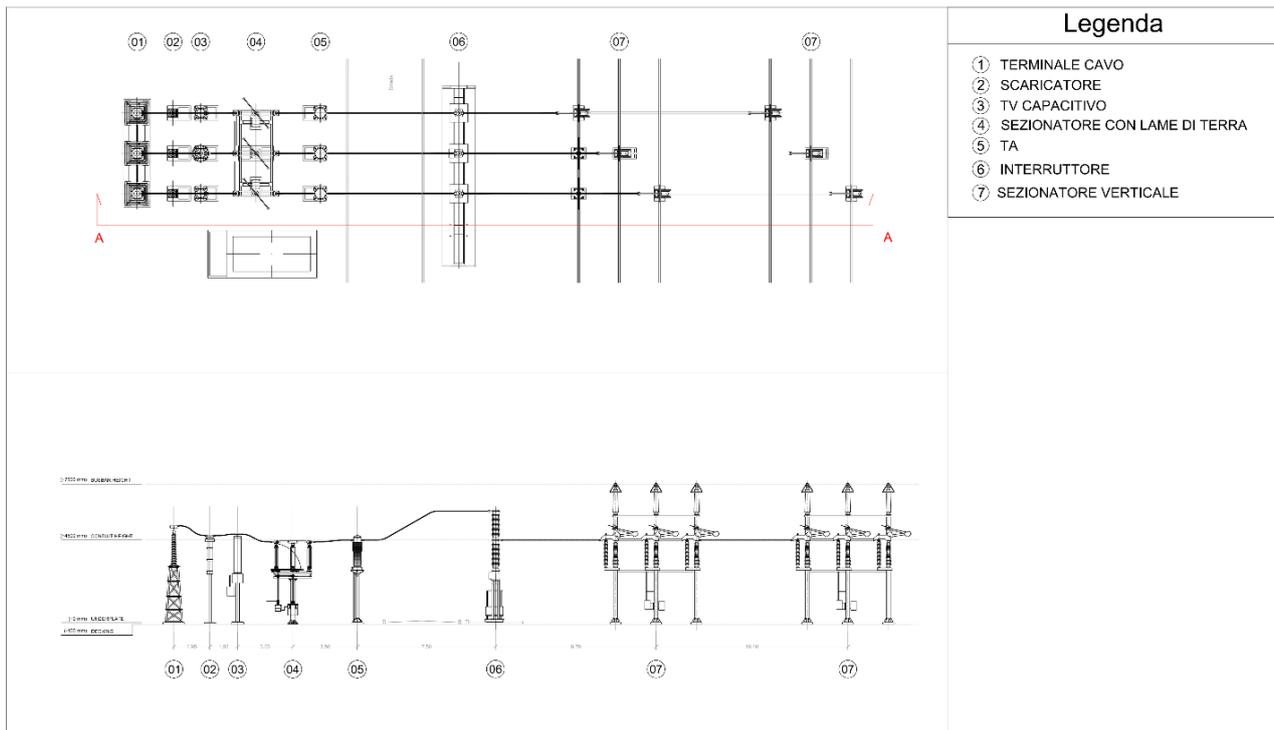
Stallo RTN - Planimetria e sezione elettromeccanica
